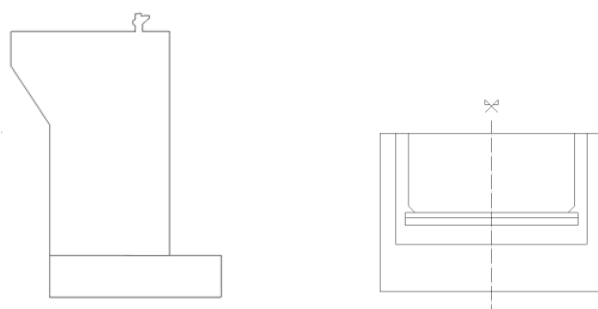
a. Esquema del perfil y la planta de estribos y cimentación
